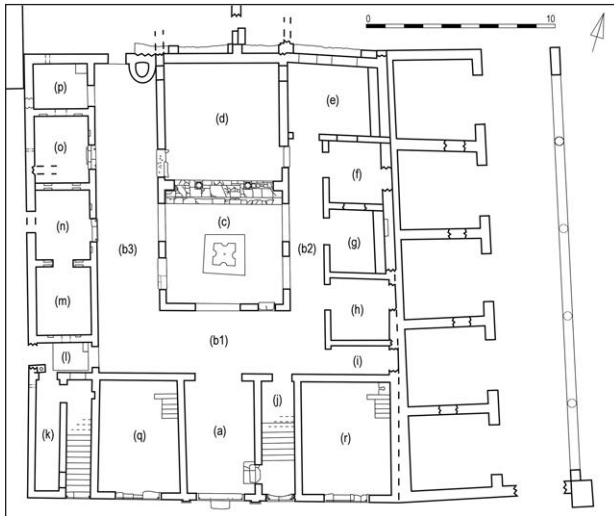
Domus del Tempio Rotondo, Grundriss
